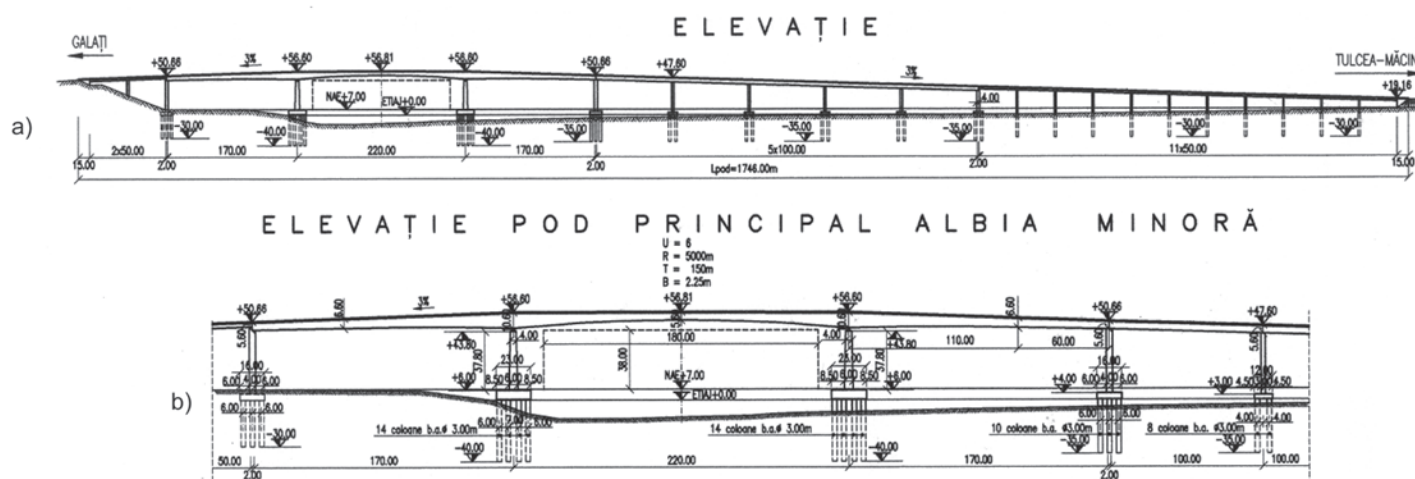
Dispoziție generală soluția cu grinzi continue cu placă din beton armat în conlucrare și soluția cu cadre continue din beton armat precomprimat cu execuție în consolă
